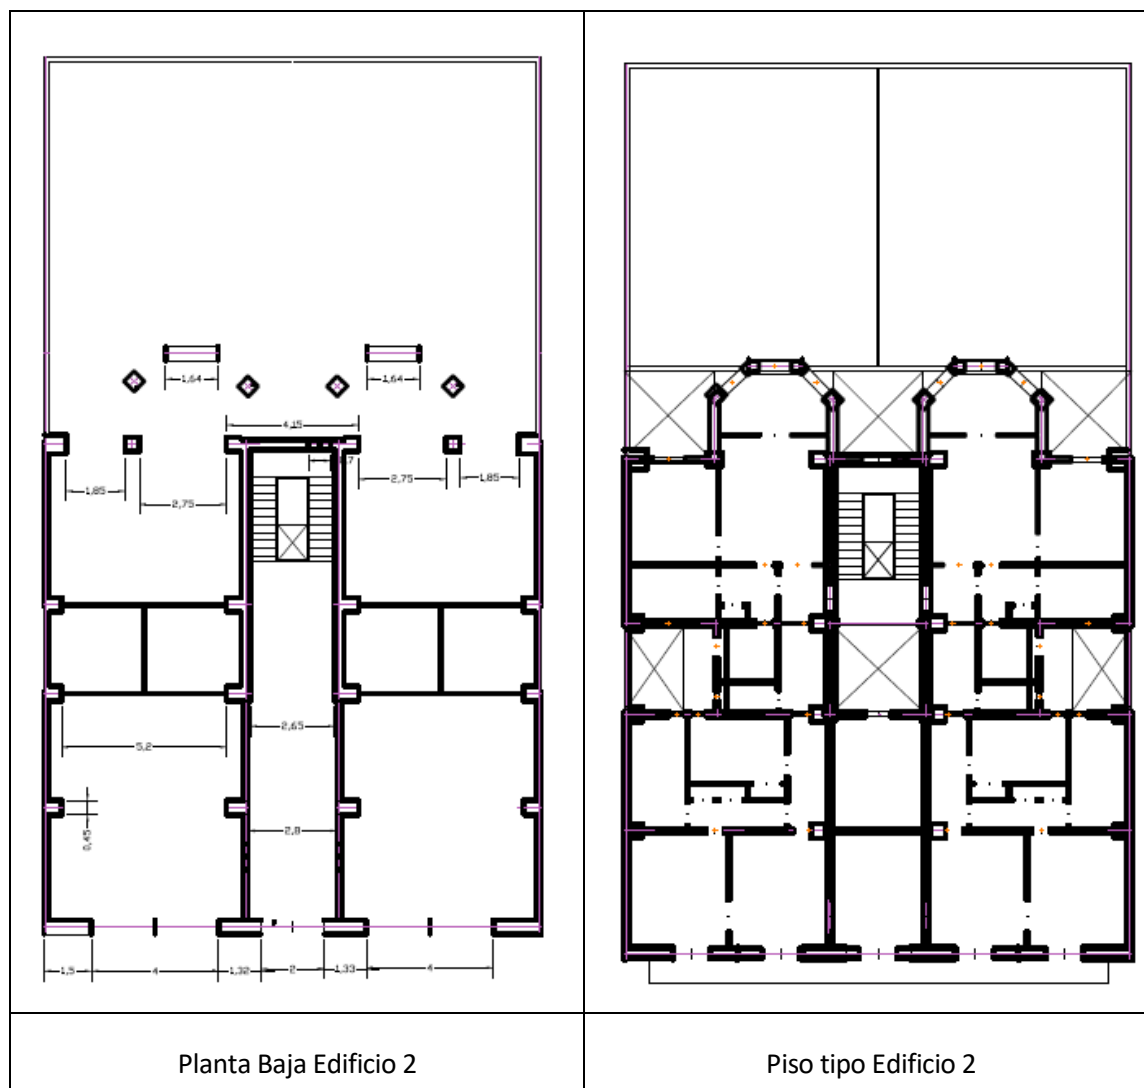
Distribución de las plantas del Edificio 2 (Fuente: Jorge Arturo Ávila Haro)
